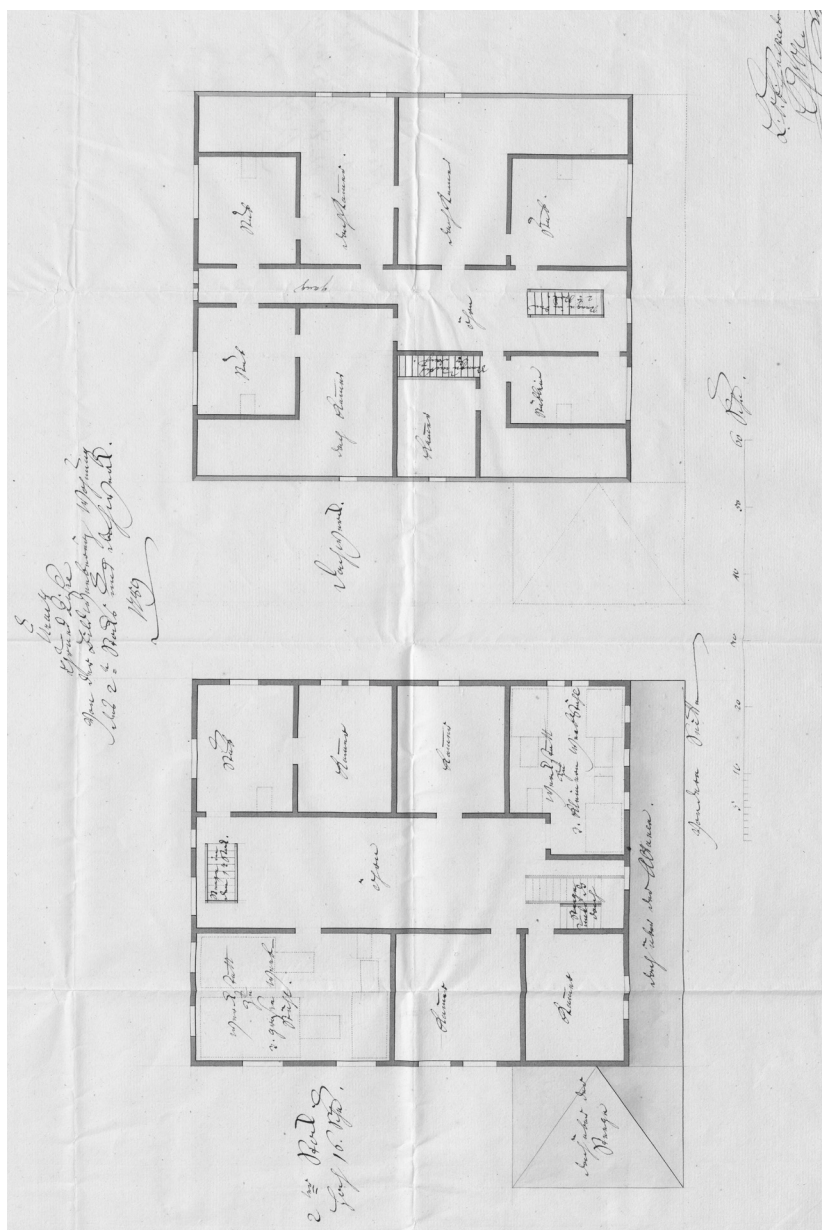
Altes Schloss Urach, Grundriss zweites Obergeschoss und Dachgeschoss von Johann Adam Groß d.J., 1789 (Vorlage: HStAs A 248 Bü 289).
